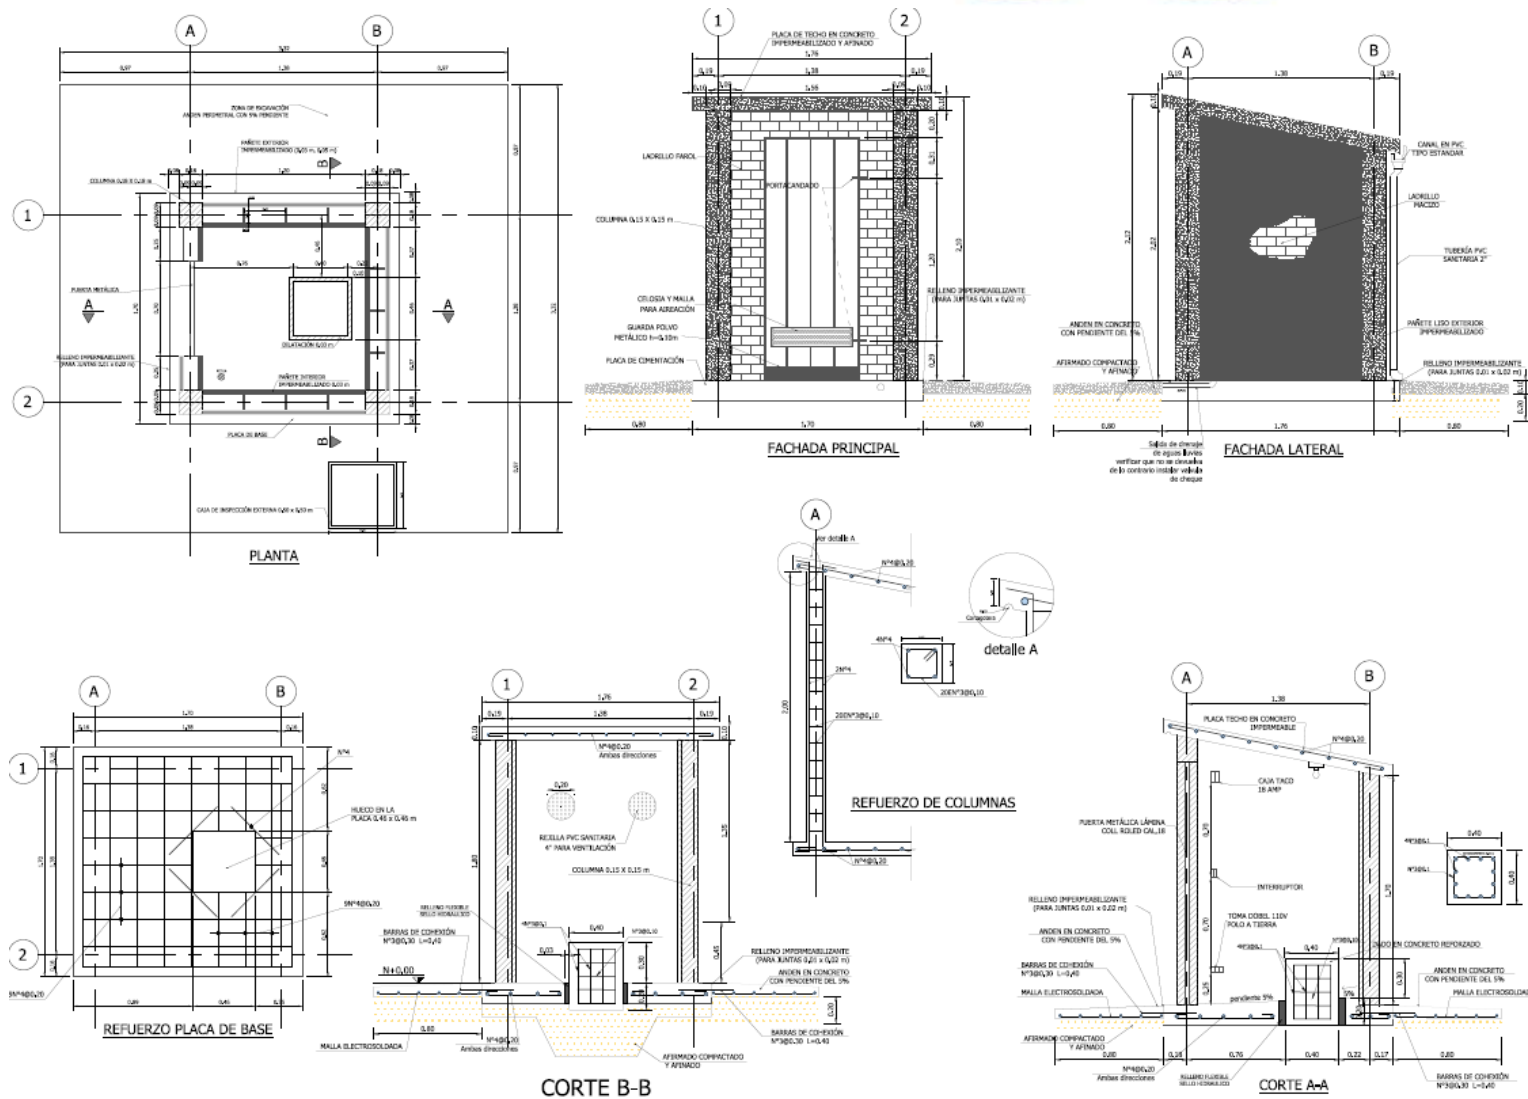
Planos estructurales para construcción de las casetas nuevas
